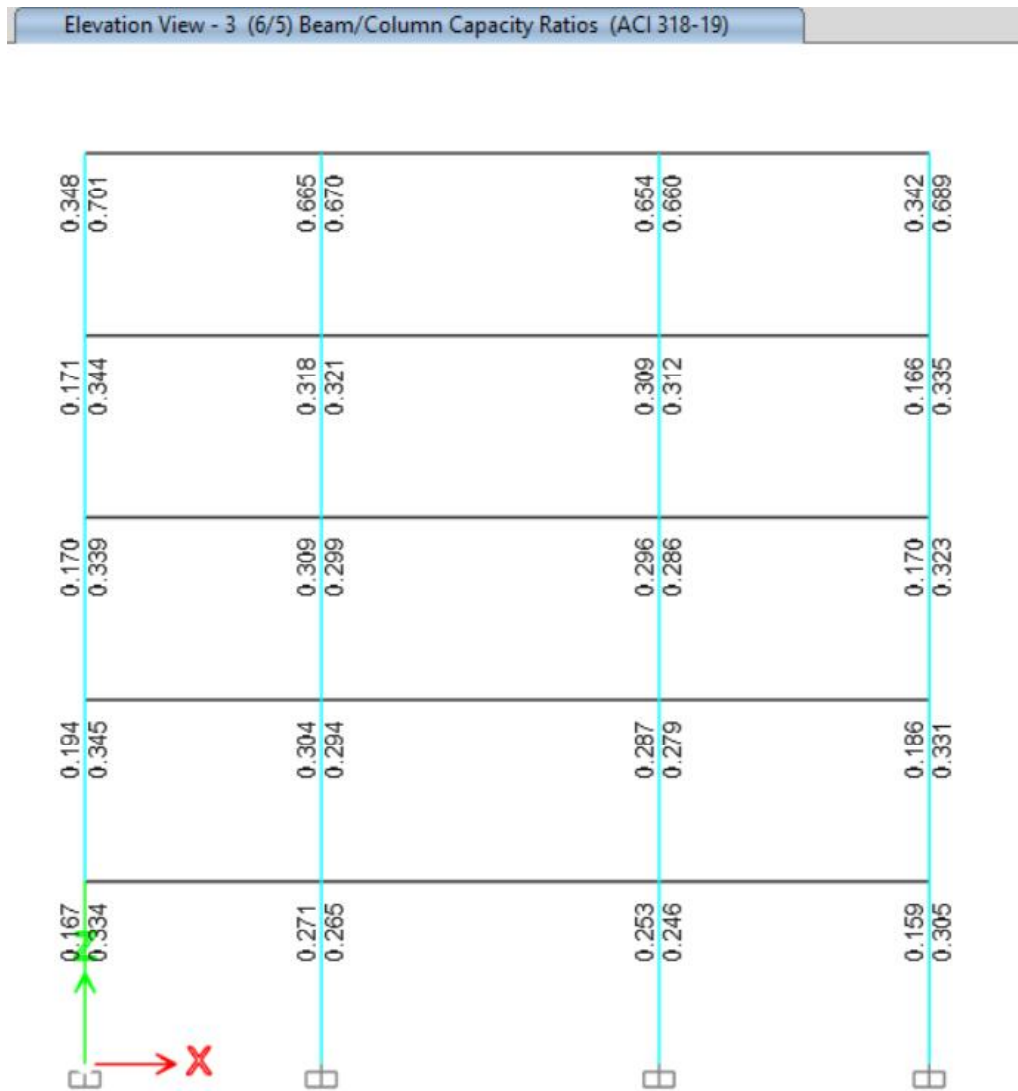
Chequeo conexión viga- columna. Columna fuerte- Viga débil - Estructura 5 Pisos
